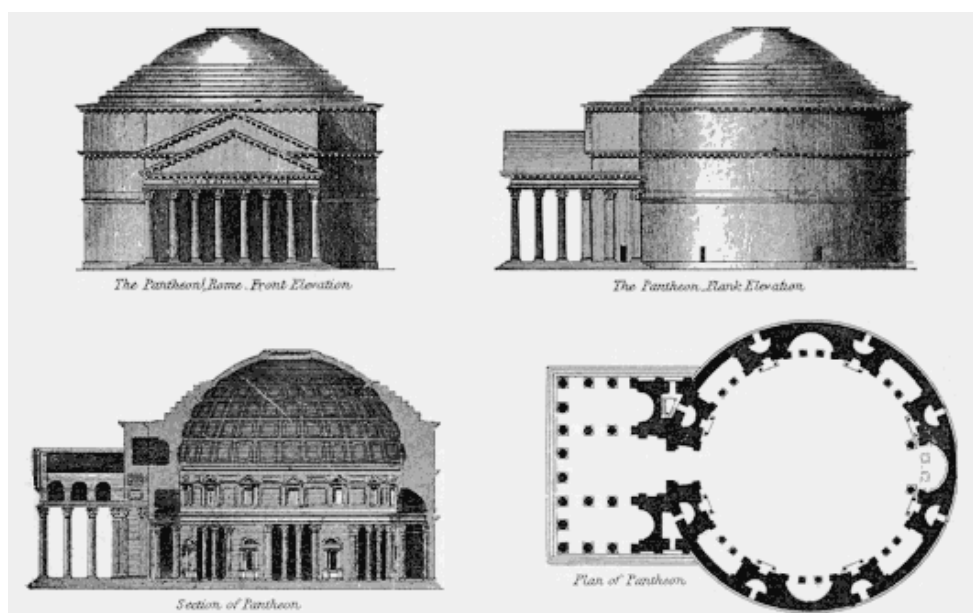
Pantheon: planta, corte e elevações (Fonte: internet)
